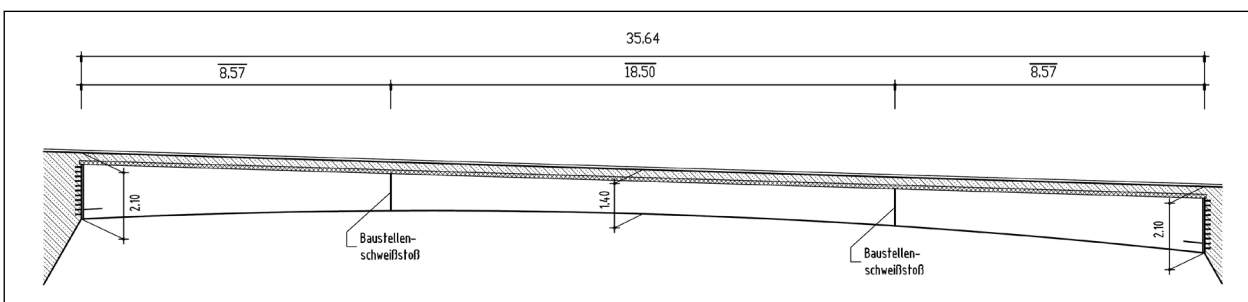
Ansicht Stahlverbundträger, Baustellen-schweißstöße, Auszug Korrosionsschutzplan (DEGES)
